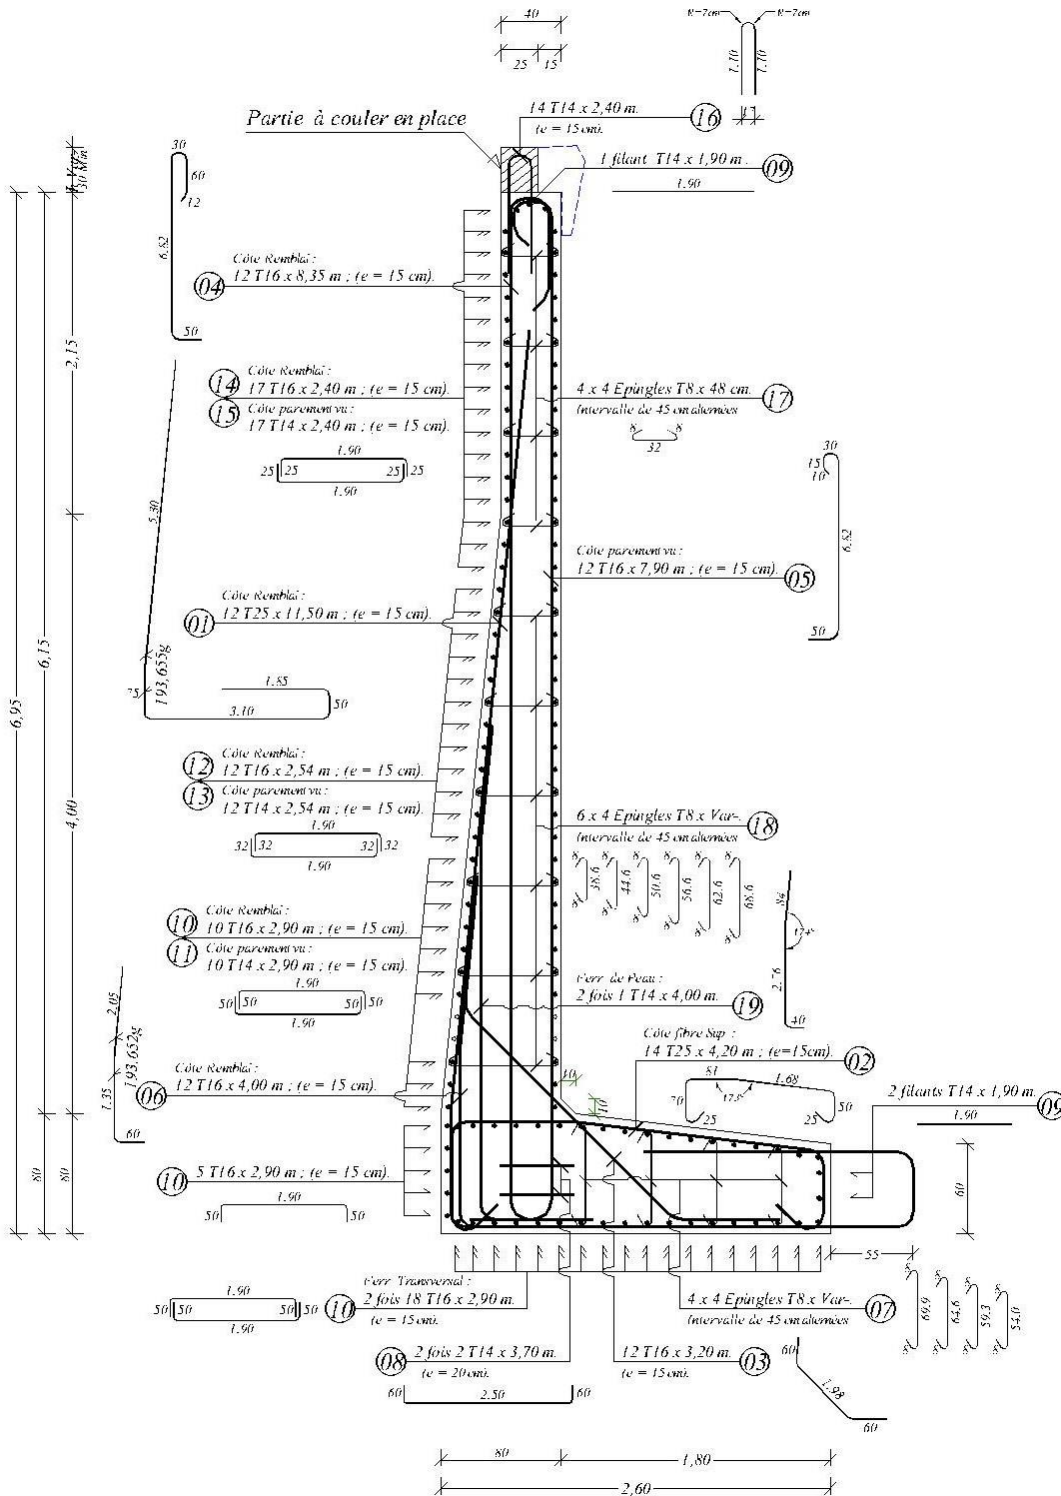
Exemple de ferrailage du mur type « 02 » (H=6,50m)
